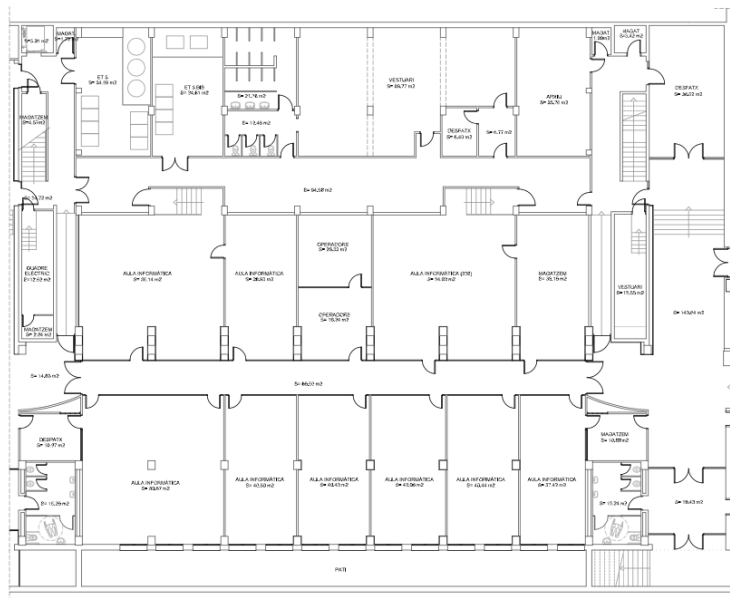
Plànol de la planta soterrani de l'aulari 2.
